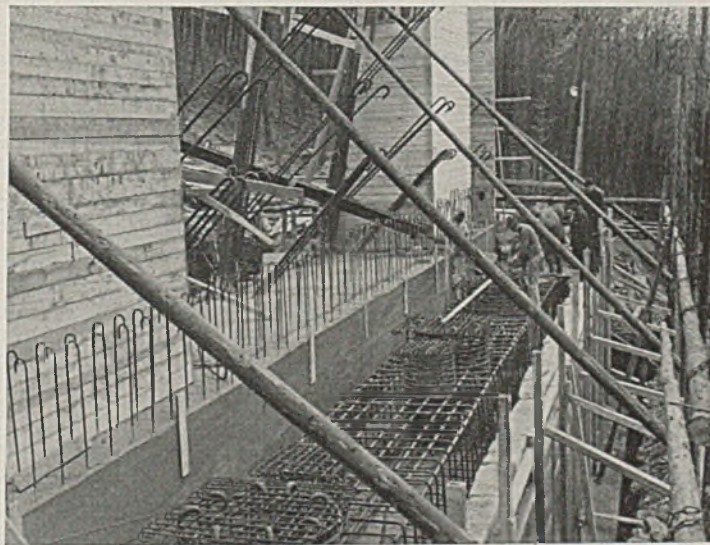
Bewehrung der Auflagerbank eines Widerlagers.
